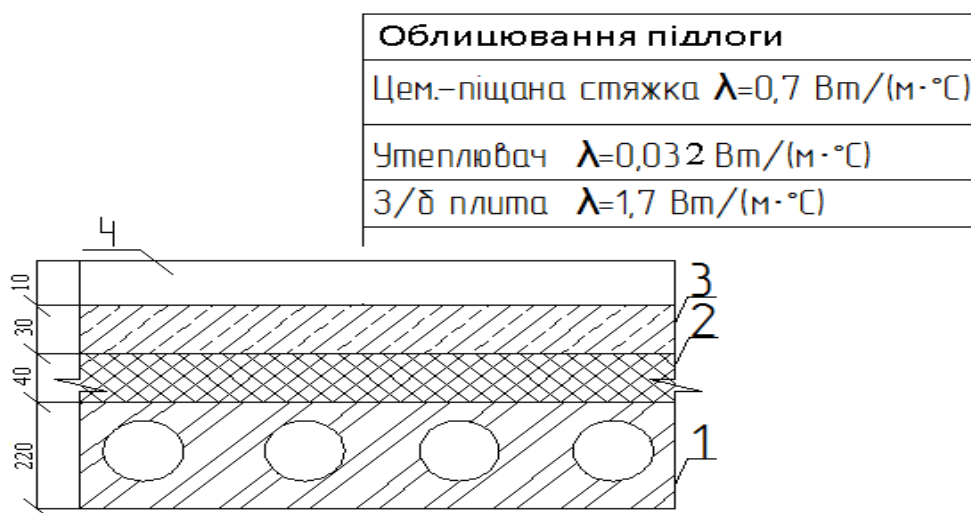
Схема до теплотехнічного розрахунку міжповерхового перекриття: 1 – багатопустотна залізобетонна плита; 2 – утеплювач – пінополістирол екструдований; 3 – стяжка з цементно-піщаного розчину.
